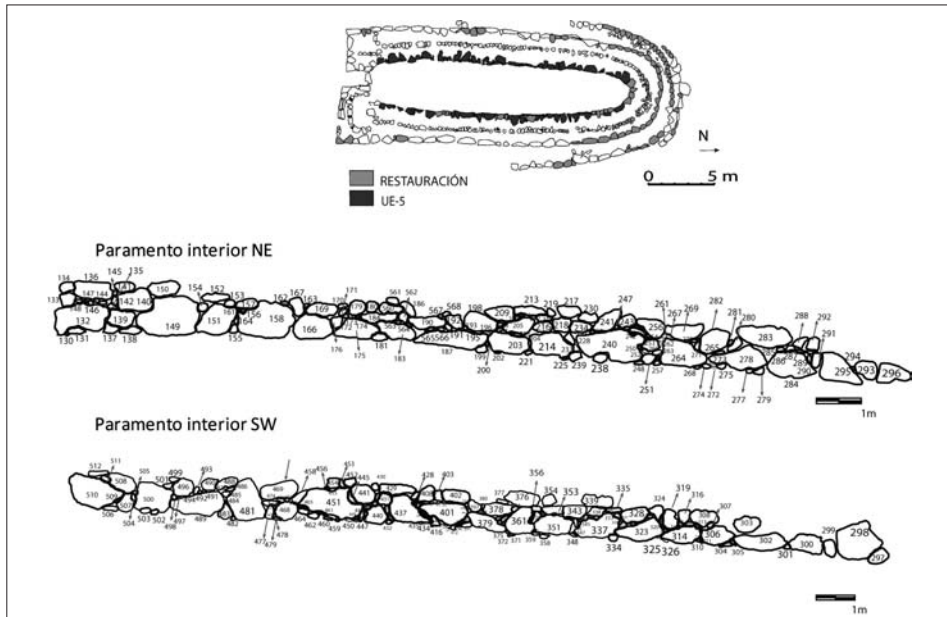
Secuencia constructiva de los paramentos internos del muro del navetiforme
